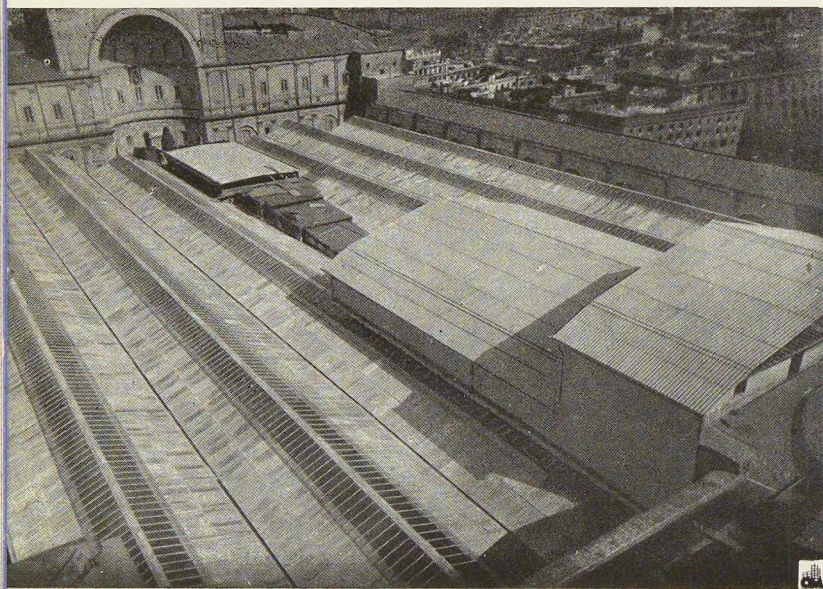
Vue à vol d'oiseau, des bâtiments construits dans la cour de la Pigna. On voit les 6 corps de bâtiments et, au milieu, au premier plan, la salle du trône.
